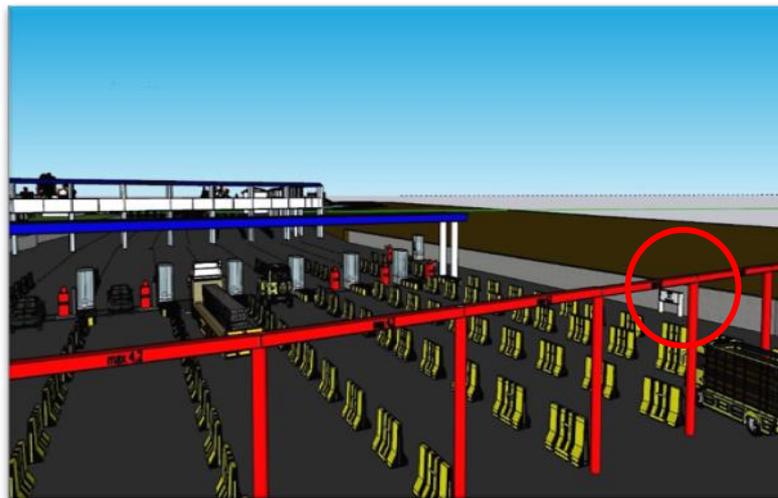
rencana lokasi penempatan papan rambu zona A3
